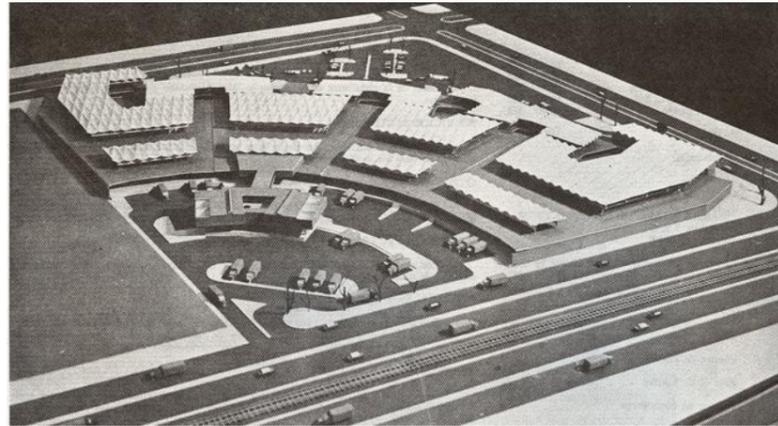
Maqueta de la Plaza de Mercado de Paloquemao. Fuente: Revista Escala # 20 - Centro de Abastos (1967)
